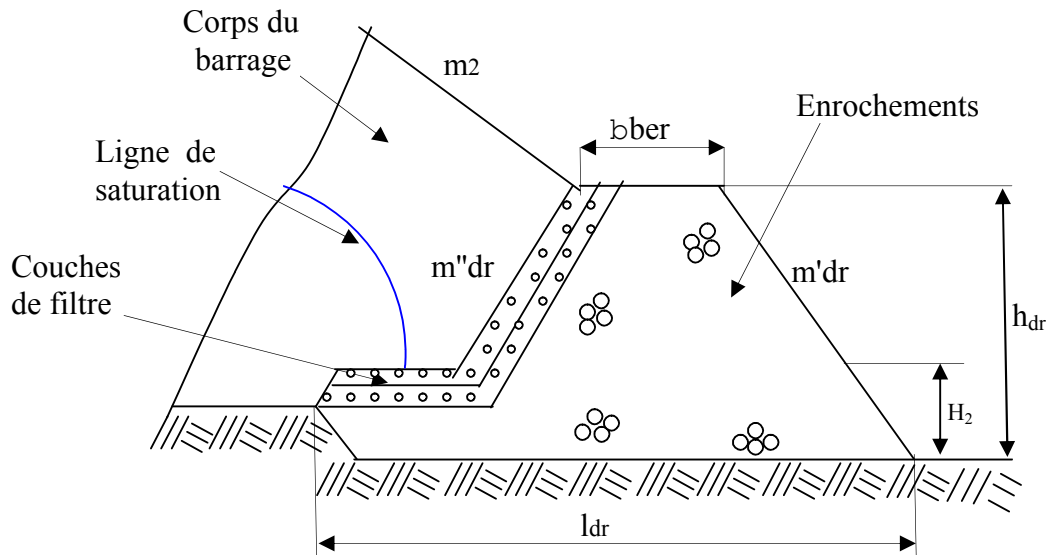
Prisme de drainage avec drain tapis interne sur fondations imperméables
